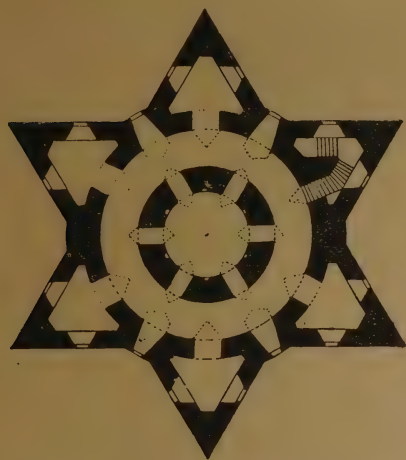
Plan du château de l'Étoile à Prague, rez-de-chaussée.
